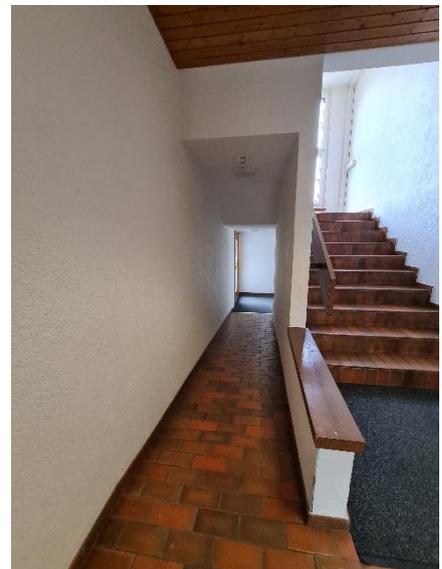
Foto behindertengerechte Rampe, EG Anbau
